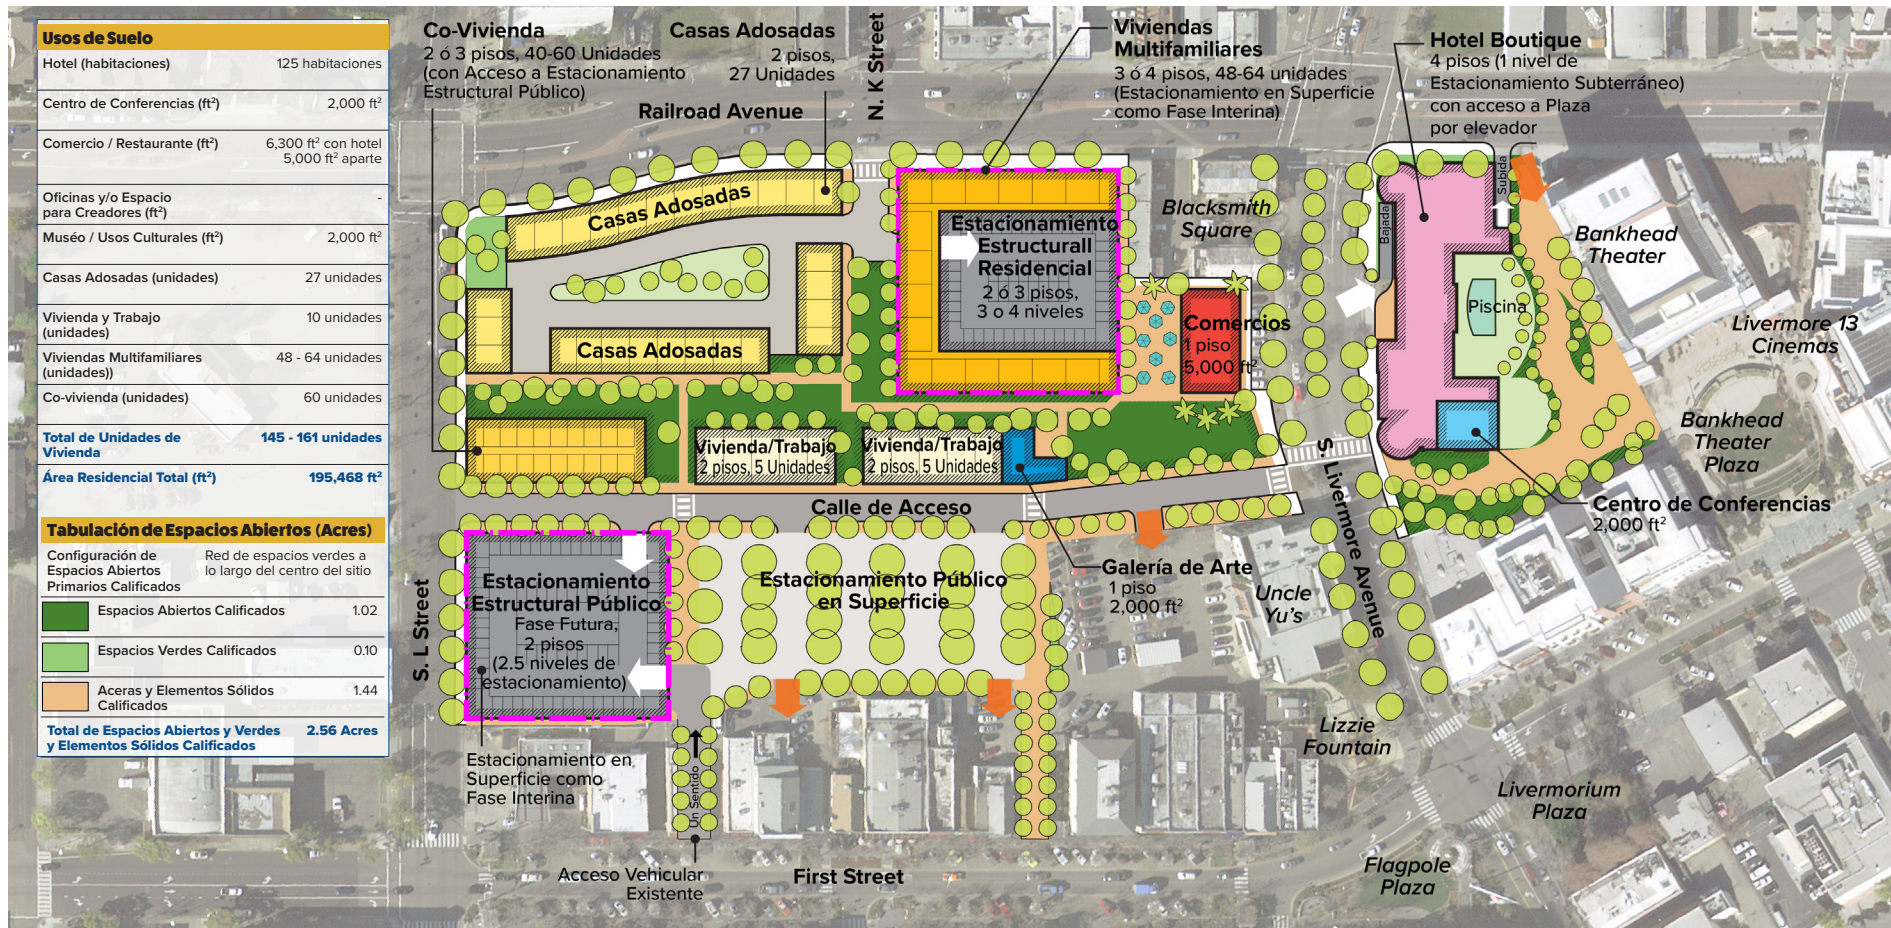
Concepto de Hotel Este A: Plano Aéreo
